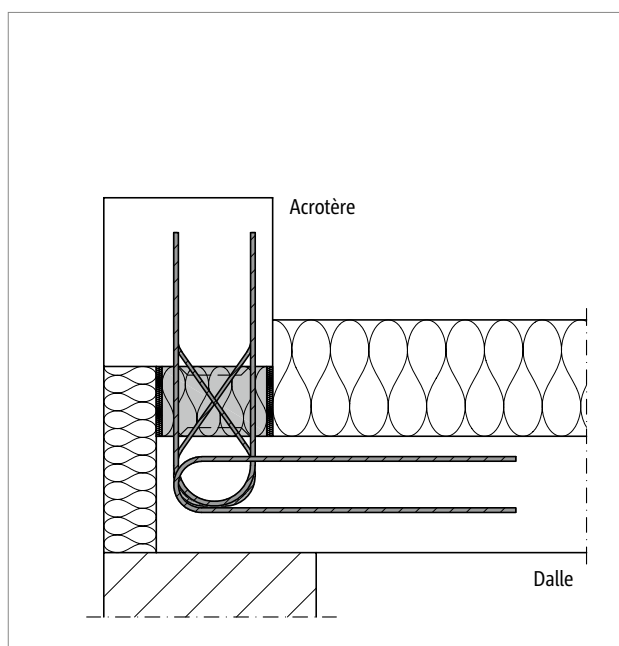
Schöck Isokorb® T Type A : Raccordement sur acrotère (Type A-MM1-VV1)
